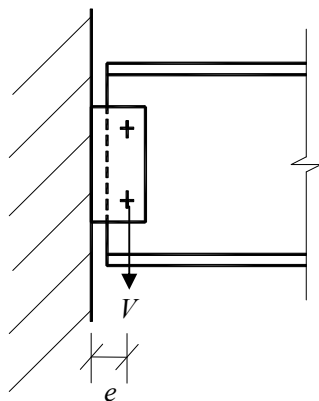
钢梁与钢筋混凝土墙的铰接
